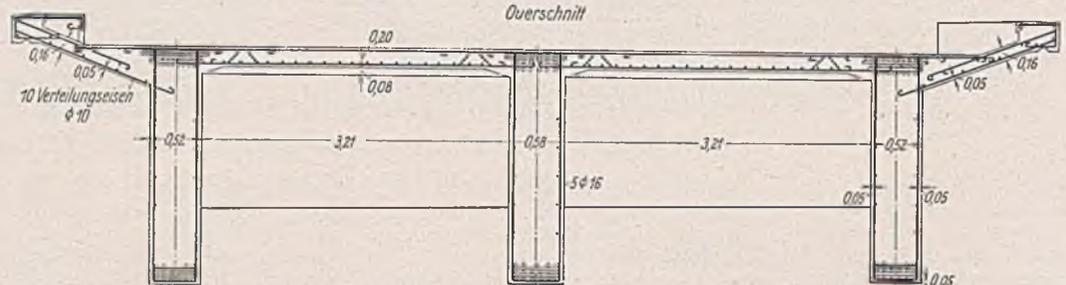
Der Querschnitt mit kreuzweis bewehrter Eisenbetonplatte.
